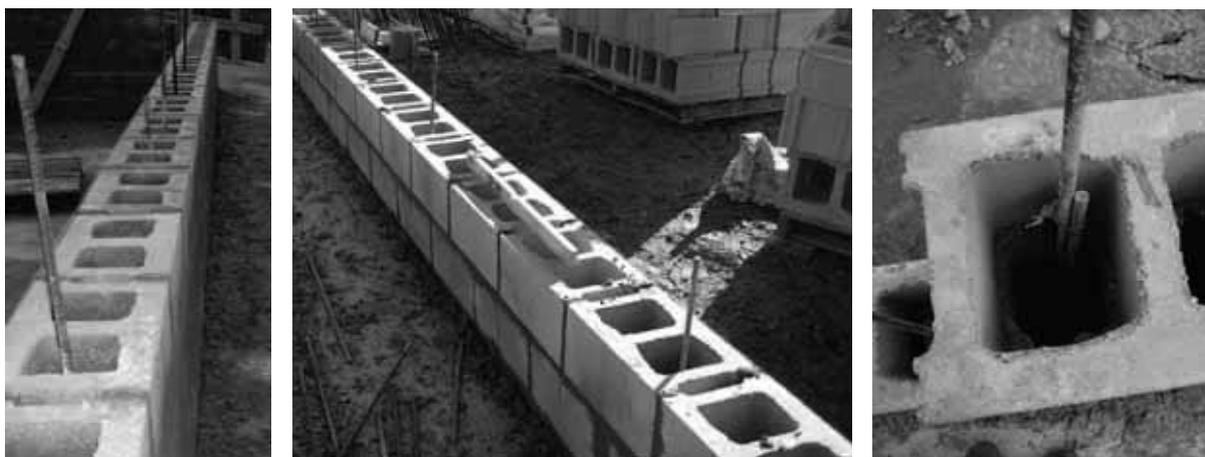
Armaduras verticales colocadas en los huecos de la fábrica. Fijación de solapes de armadura antes del vertido del mortero de relleno.
